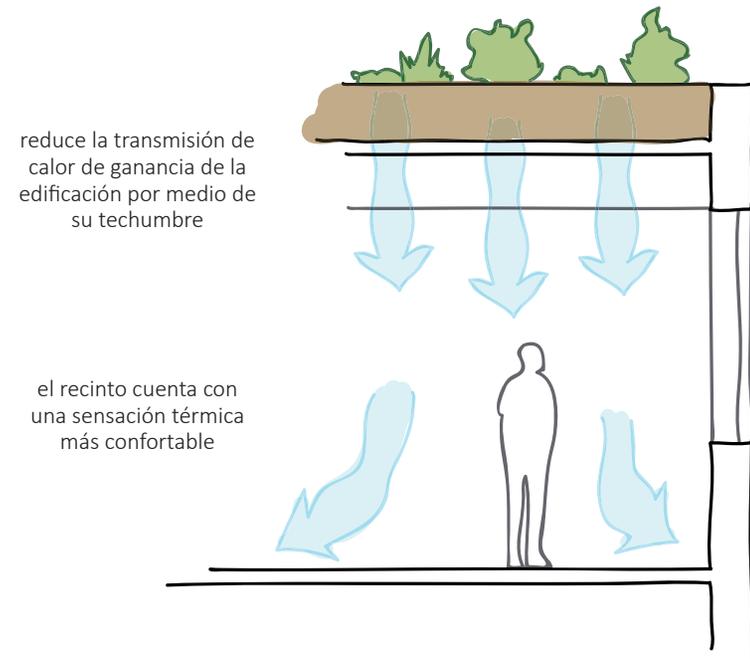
Corte esquemático cubierta vegetal. Fuente: Elaboración Propia.
